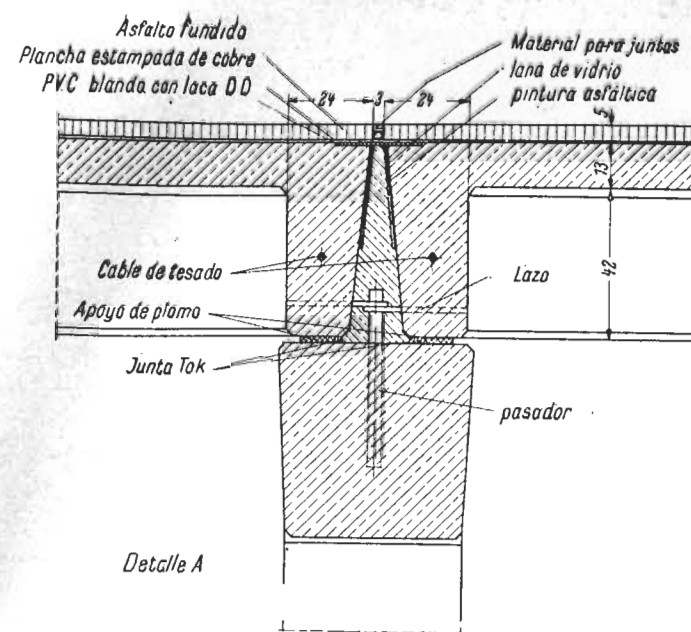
Detalle de la junta transversal en la construcción con elementos premoldeados.
